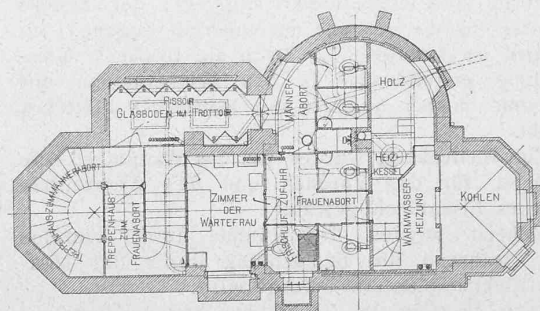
Grundriss vom Kellergeschoss 1:200.
